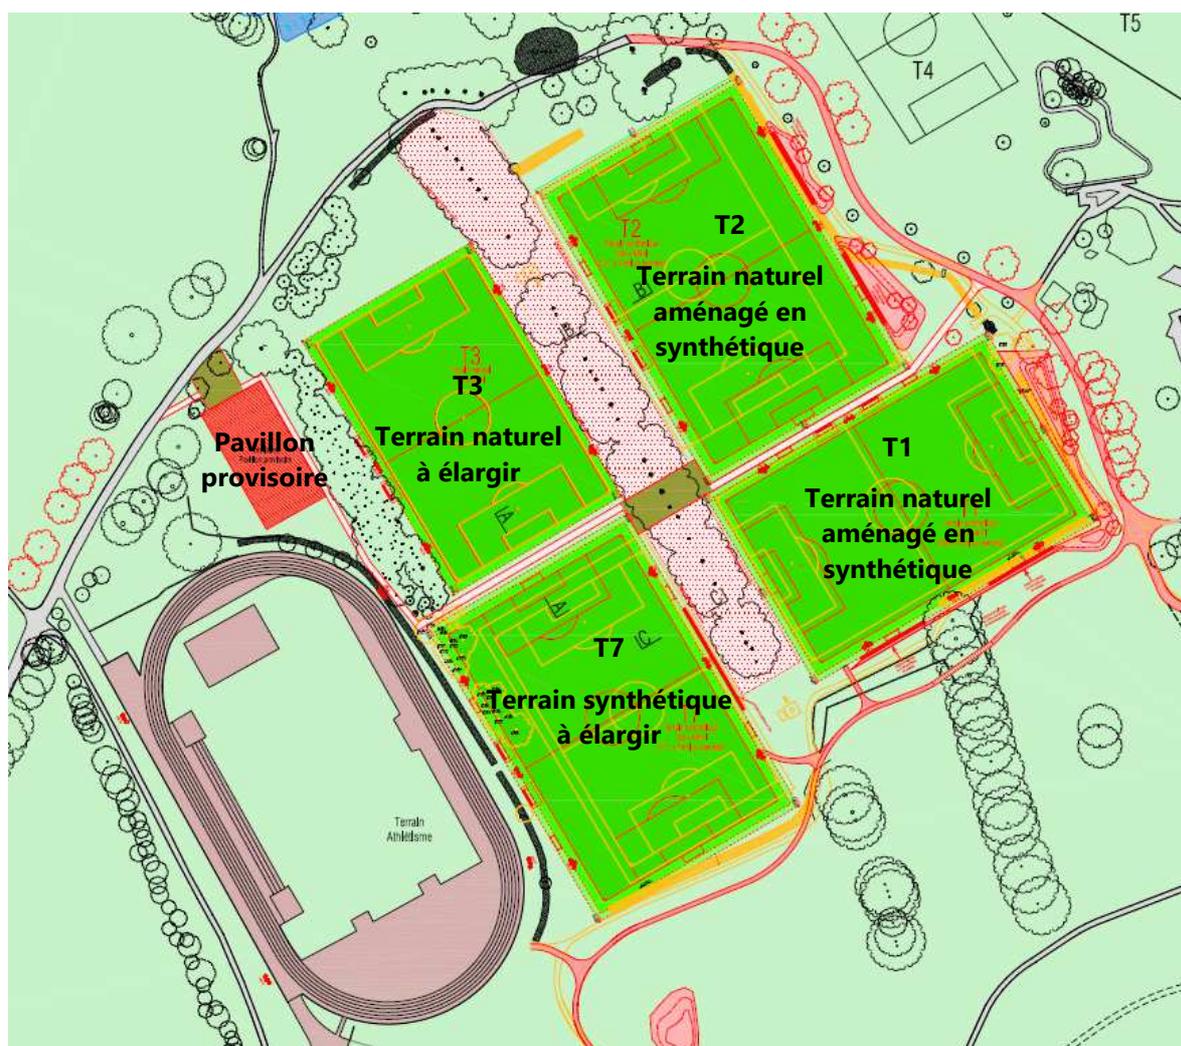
Extrait du plan de situation (source : Plan A04 du dossier de DD, BATEC, avril 2021)
